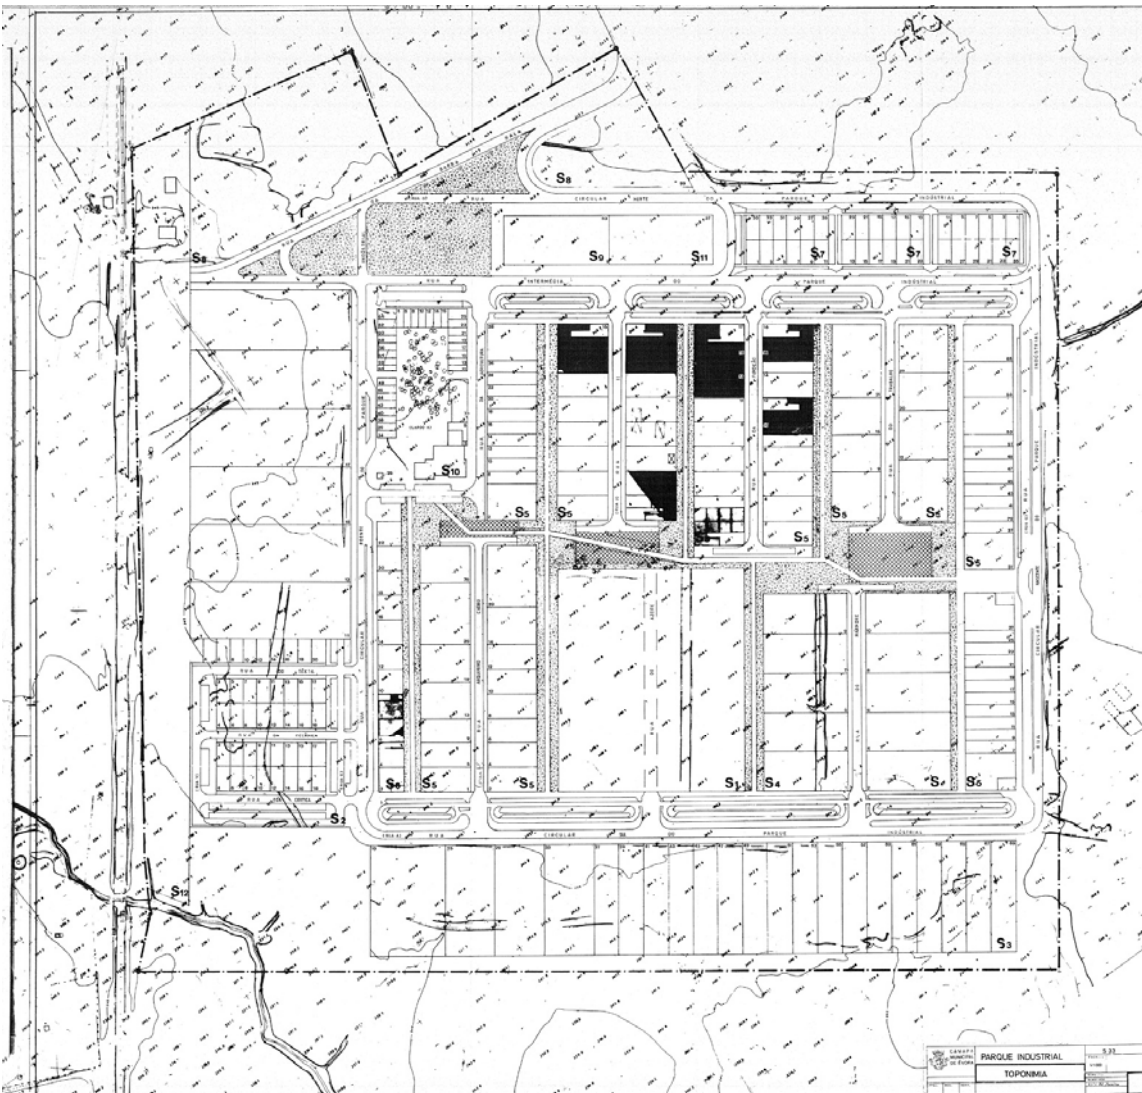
Plano de Pormenor do Parque Industrial (fonte: CME)
